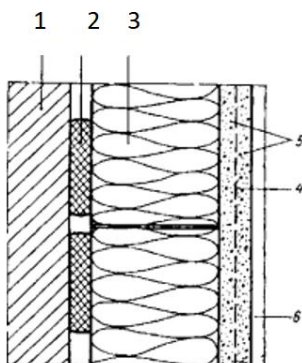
Конструкция стены с наружной теплоизоляцией с оштукатуренным плитным утеплителем: 1 – кирпичная или каменная стена; 2 – клей; 3 – плитный утеплитель; 4 – армированная сетка; 5 – штукатурное покрытие; 6 – наружный декоративный слой покрытия
